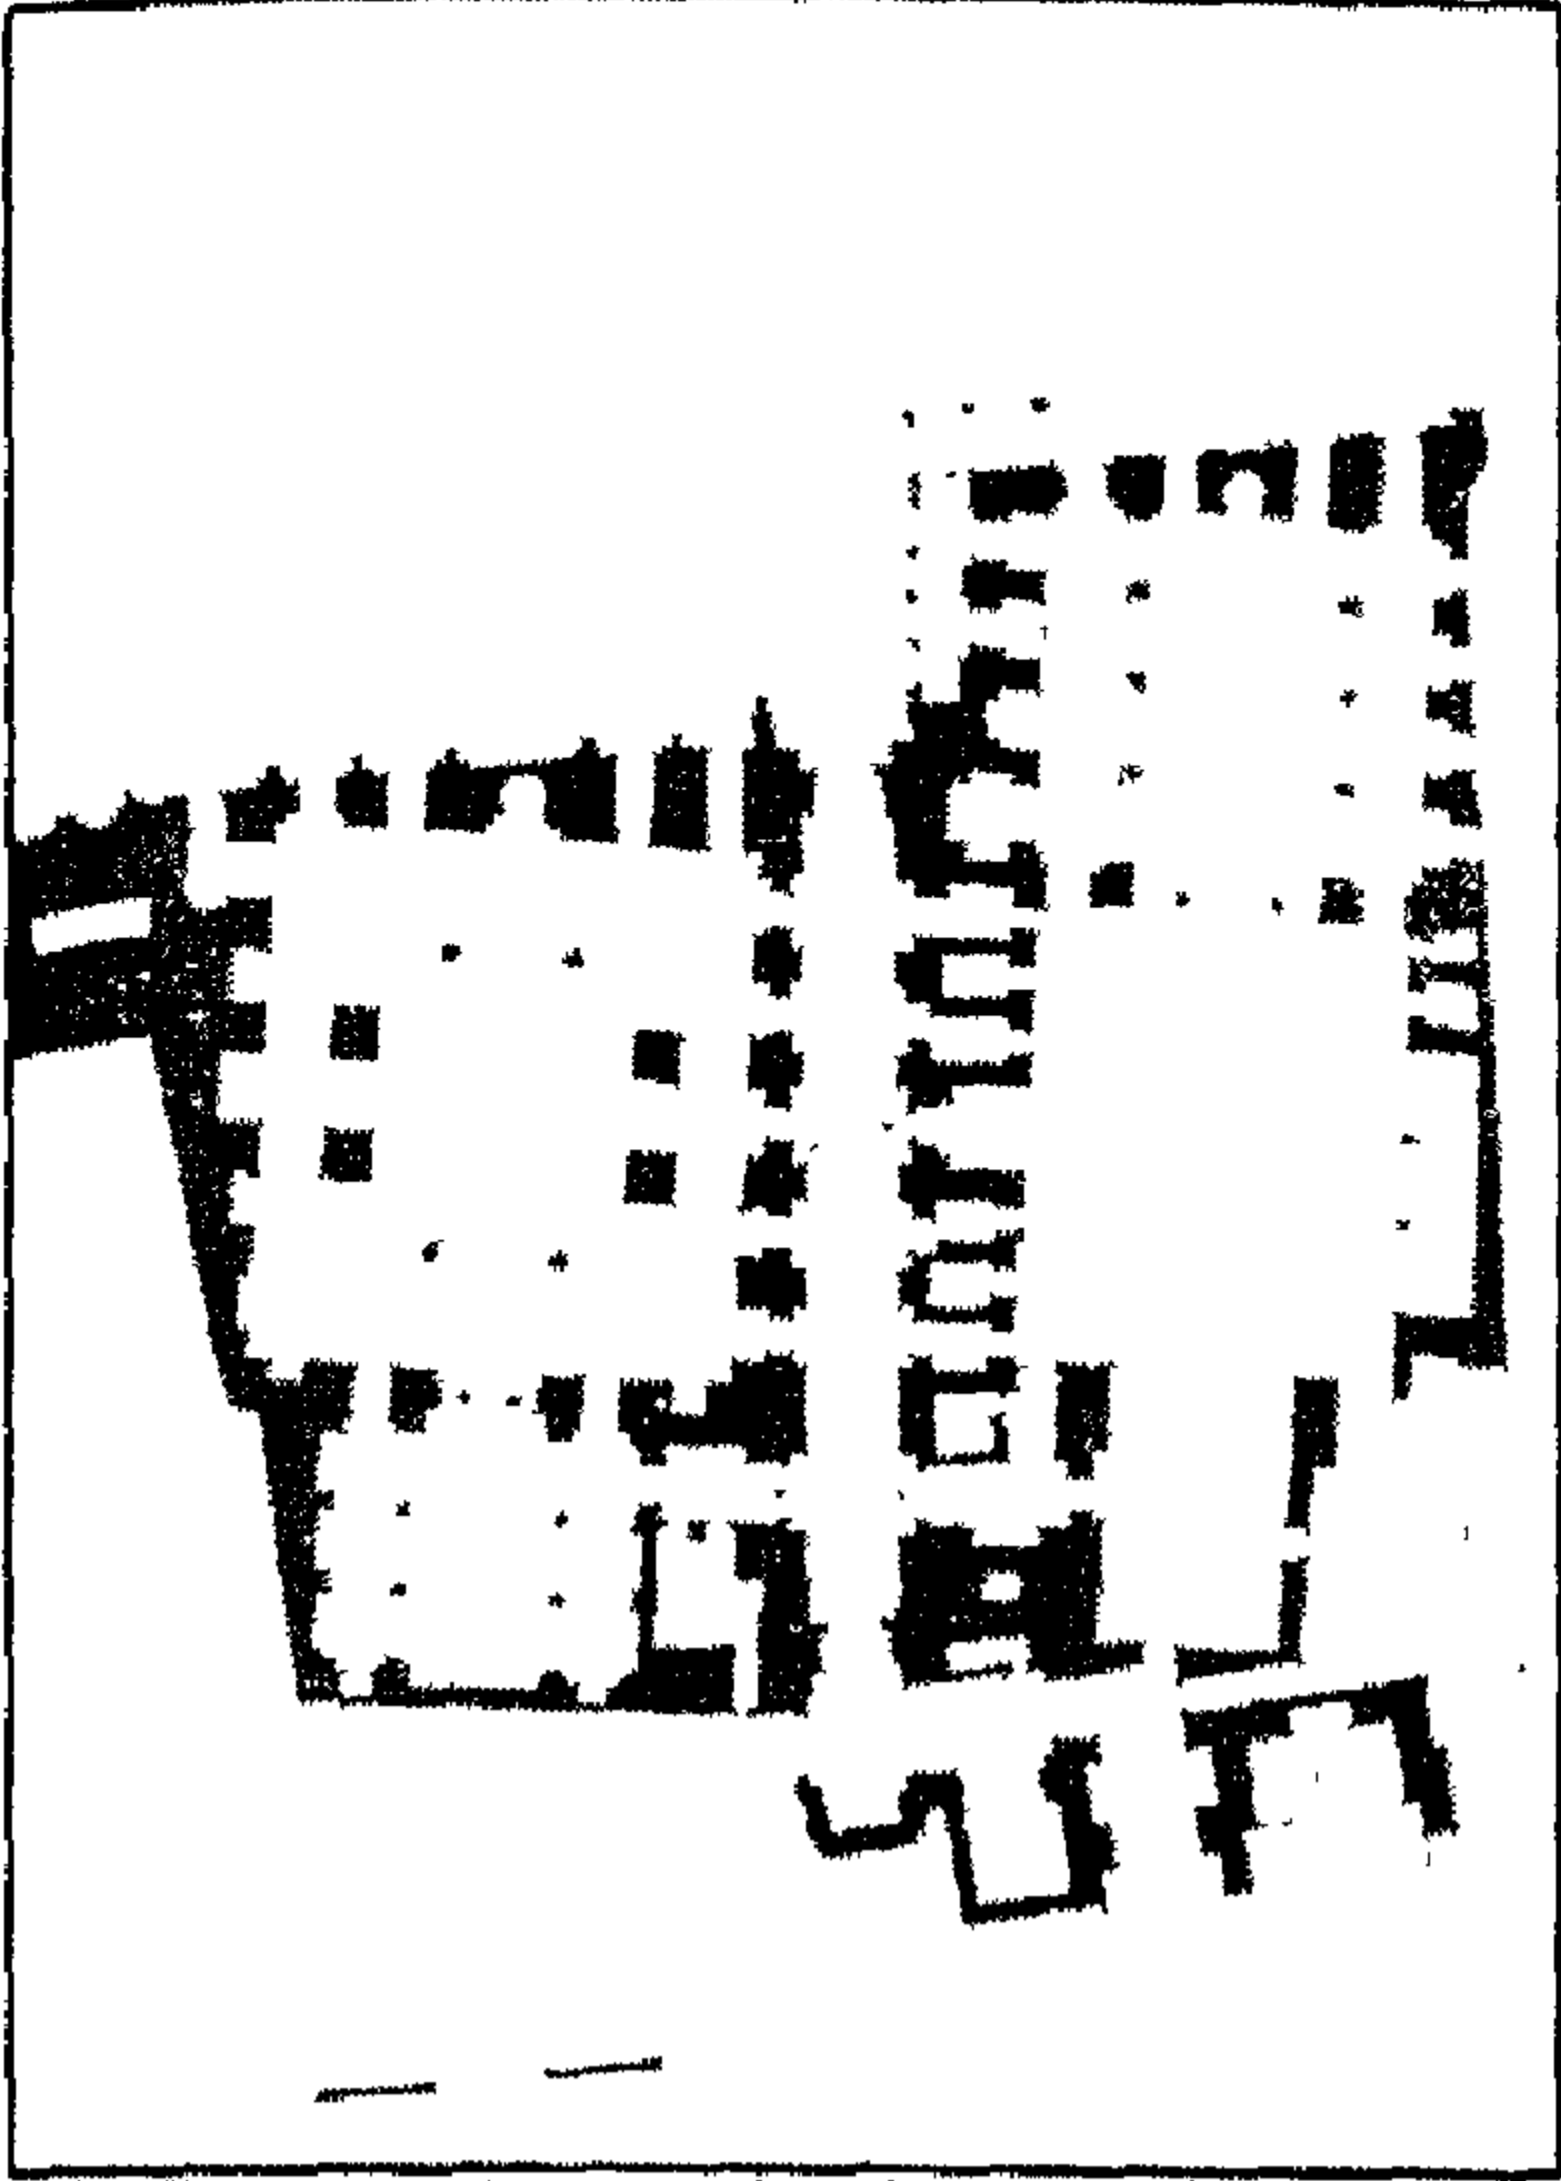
جامع الكوفة (مسقط أفقي) عن فريد شافعي
